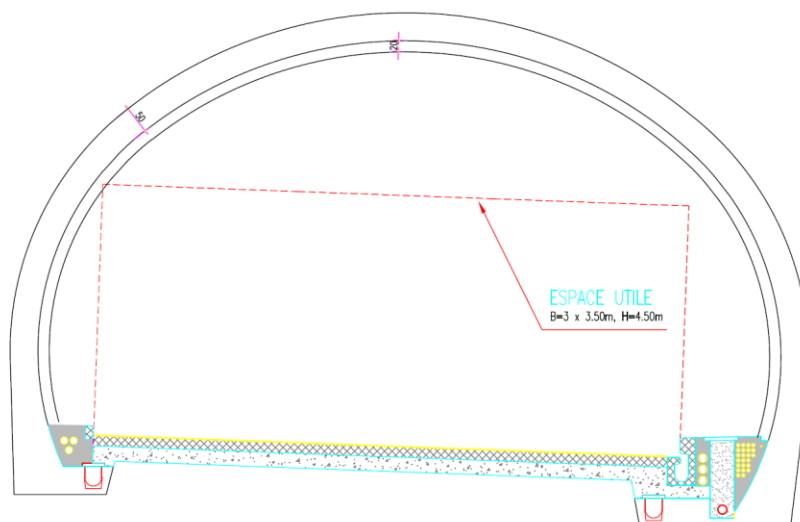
Coupe type du tunnel de la Clusette [9] avec revanche de 200 mm pour l'étanchéité future.
